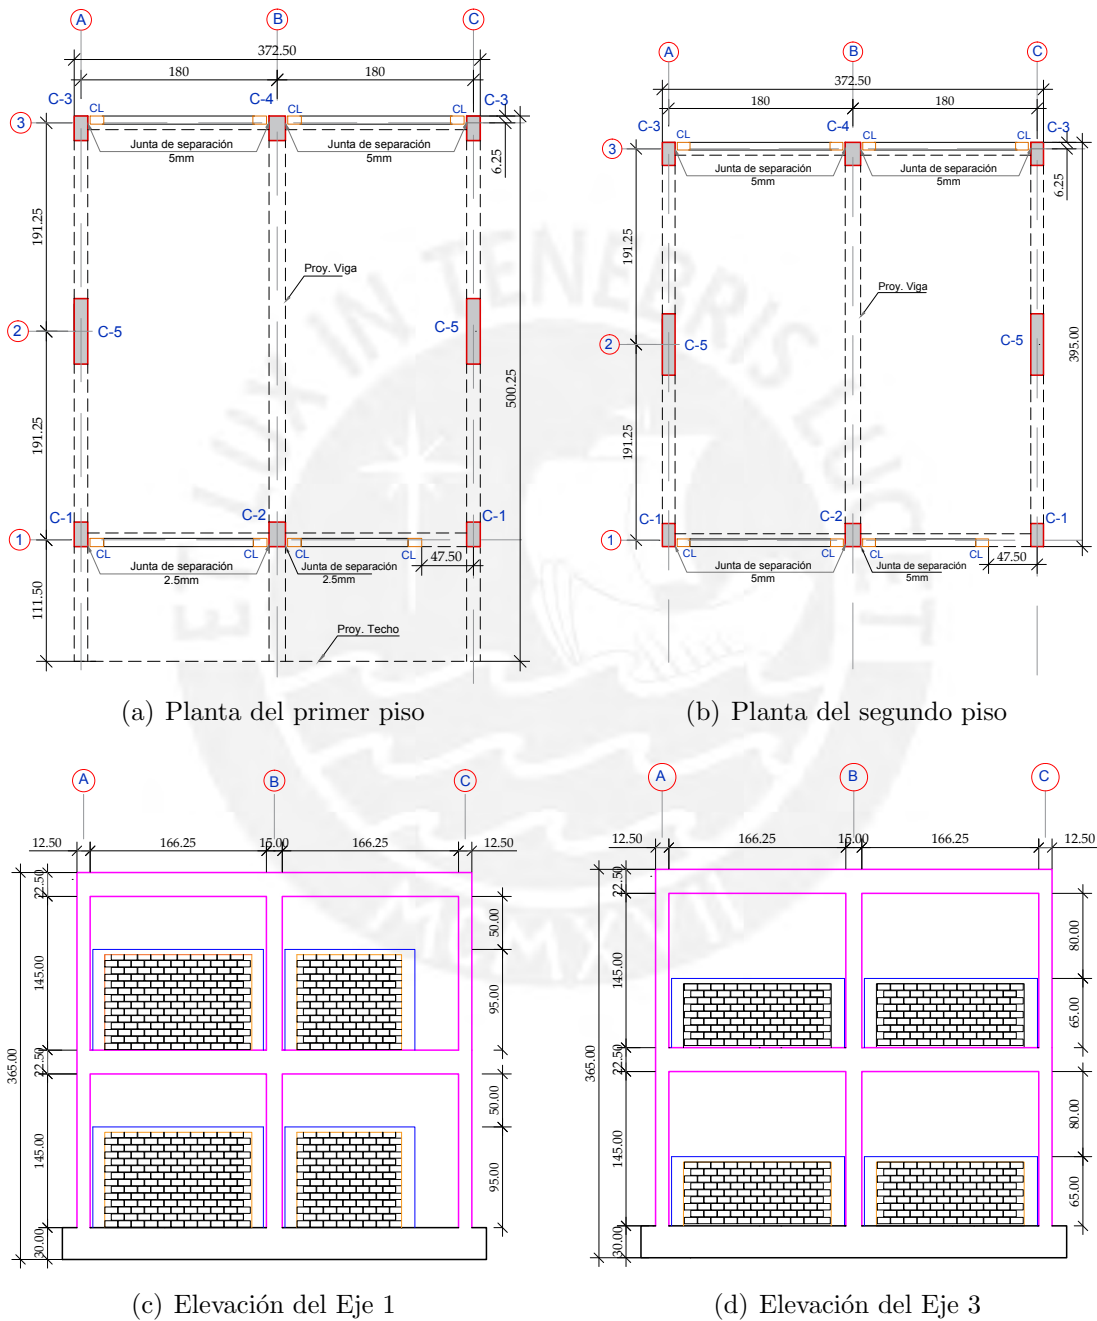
Espécimen para ensayo: Módulo 780 - Pre
